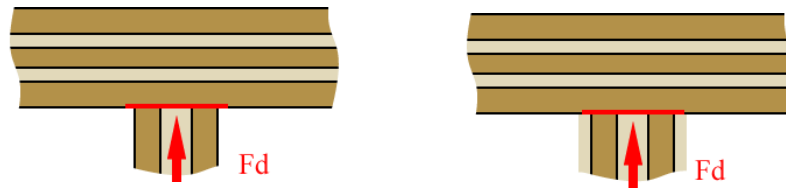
Auflagerdetail Wand-Decke für die Auflagerpressung
